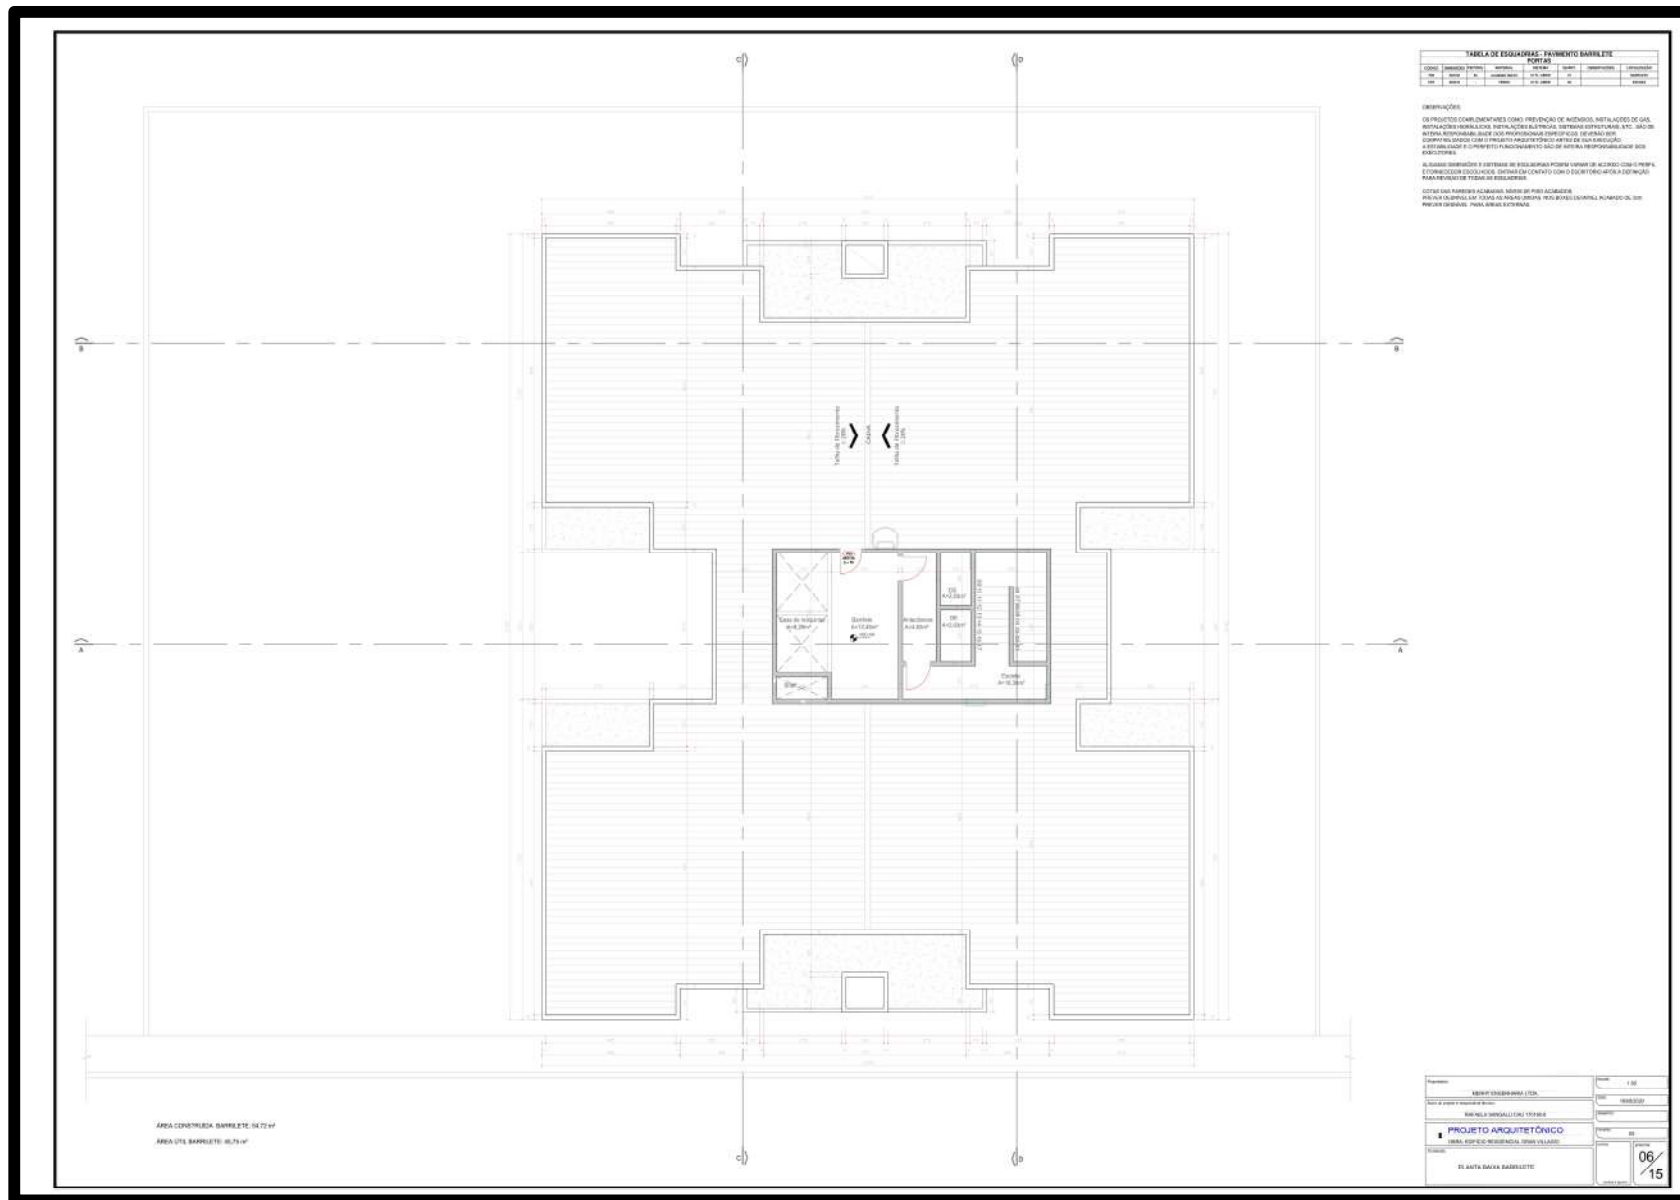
Planta barrilete. Fonte: Construtora Merhy (2020).
